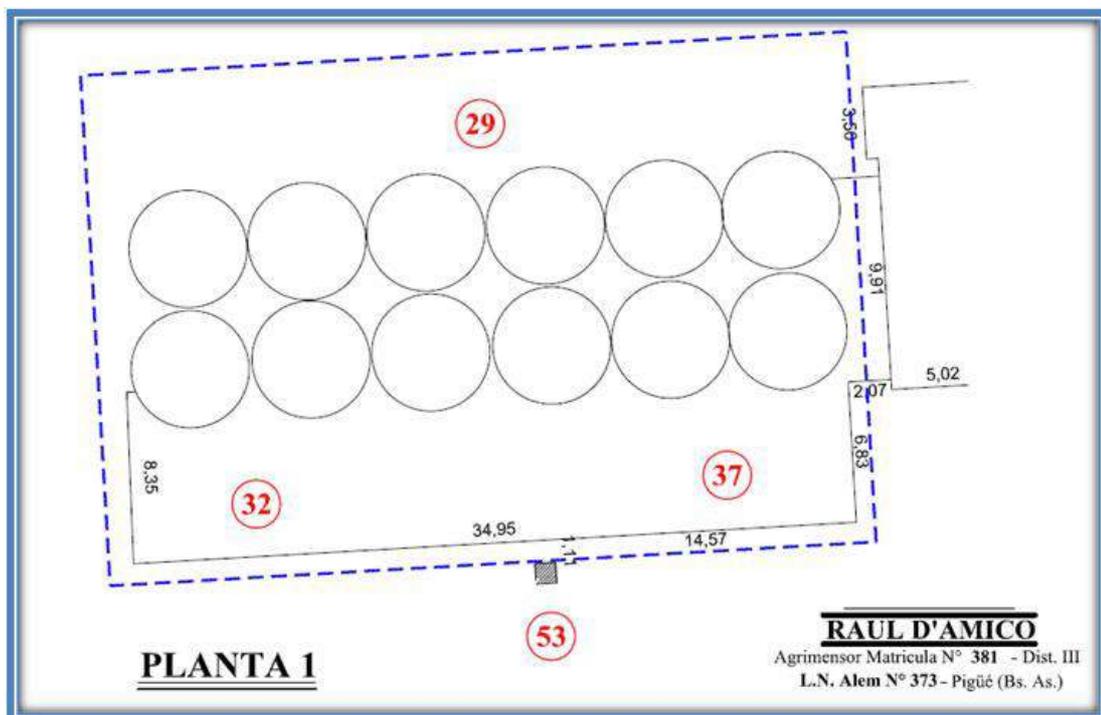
Planta de Silo 1 (Ref. n° 29)
